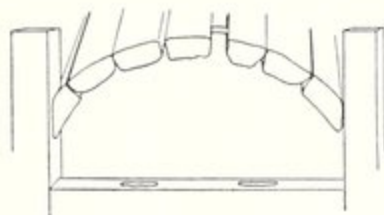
Assemblage du couvercle (41004, côté 1).
